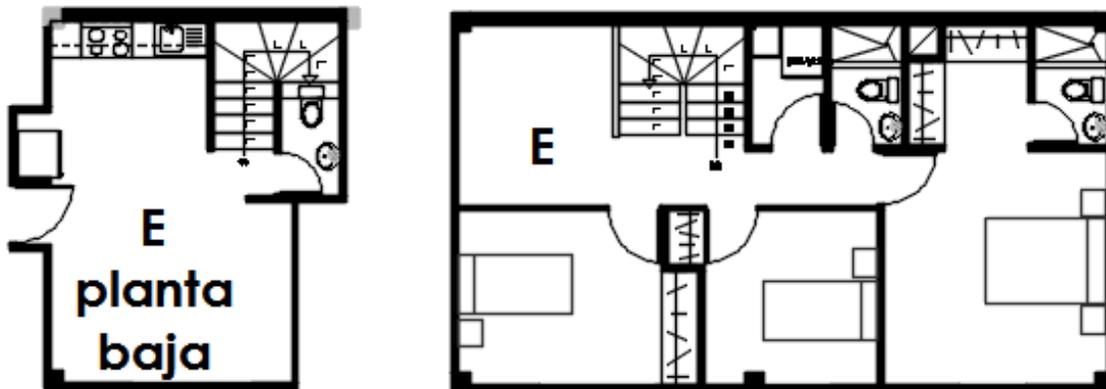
Planta arquitectónica departamento E conjunto residencial "Praderas de Bemani".
